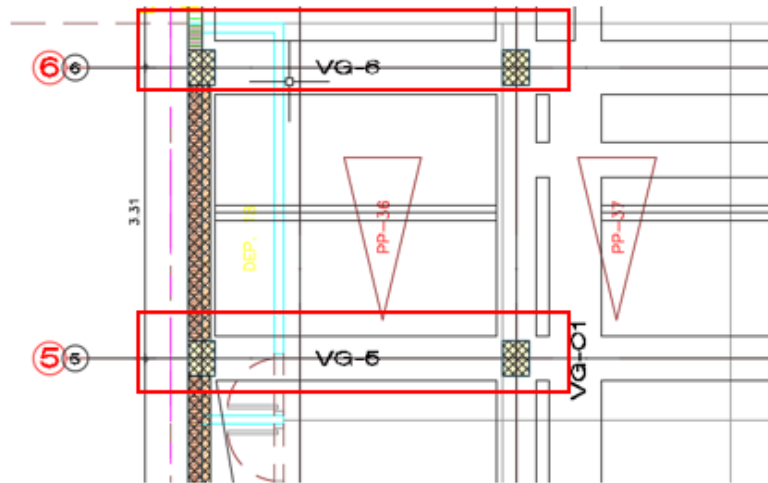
Detalle donde se ubican las irregularidades constructivas. Fuente: Propia
